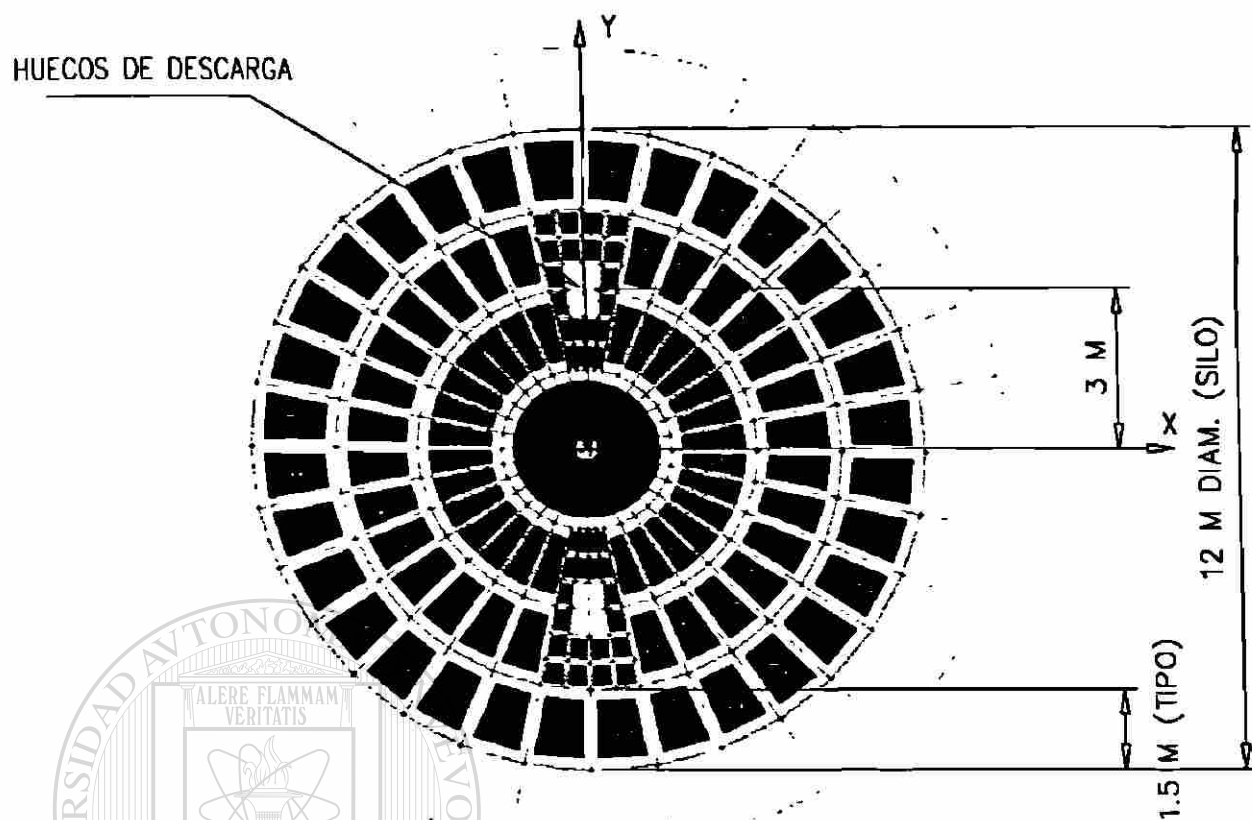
Planta de losa de fondo plano de silo de 12 m de diámetro.
